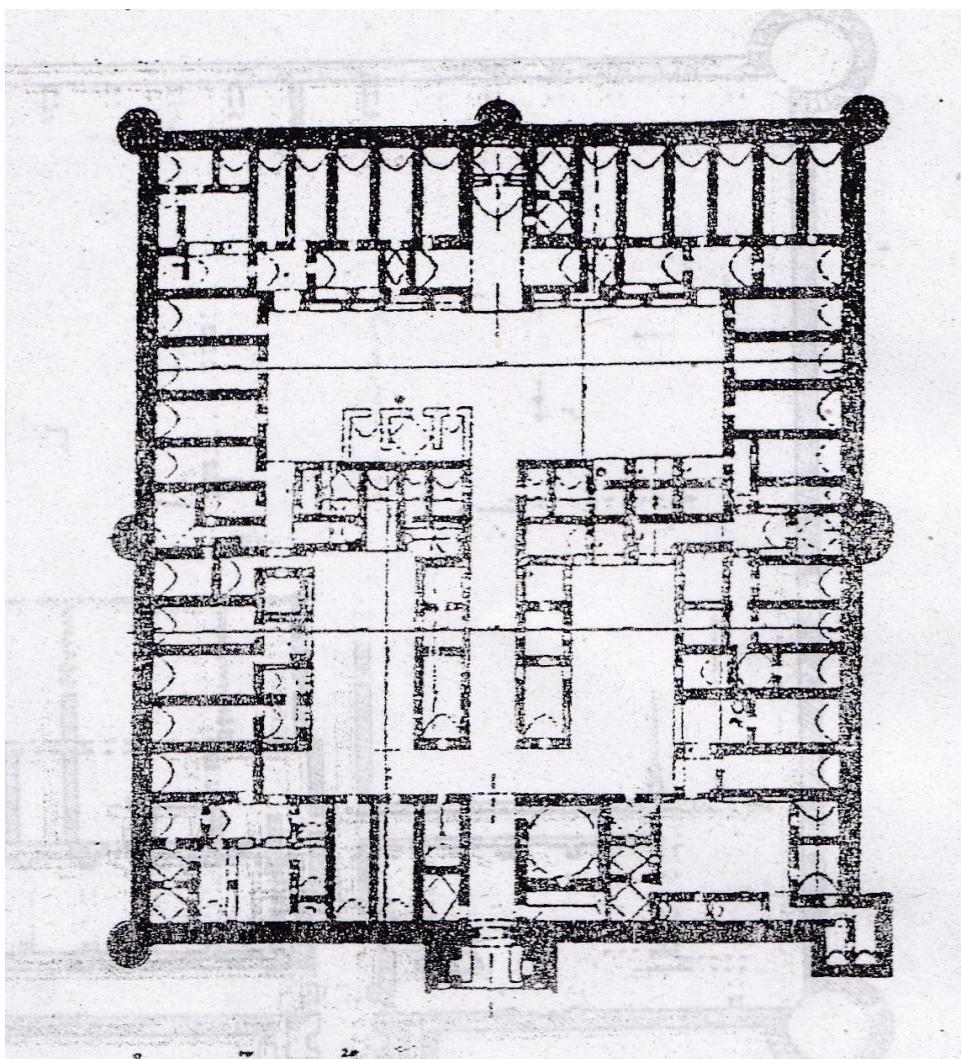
مسقط افقى لخان داهستان بایران
